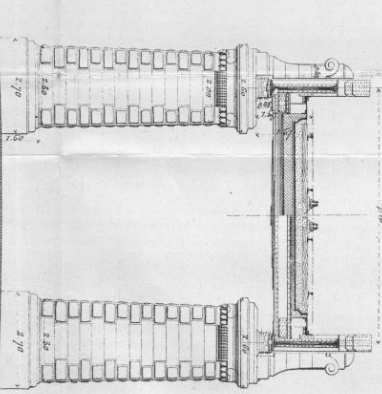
Elevation et Coupes longitudinales AB et CD.
